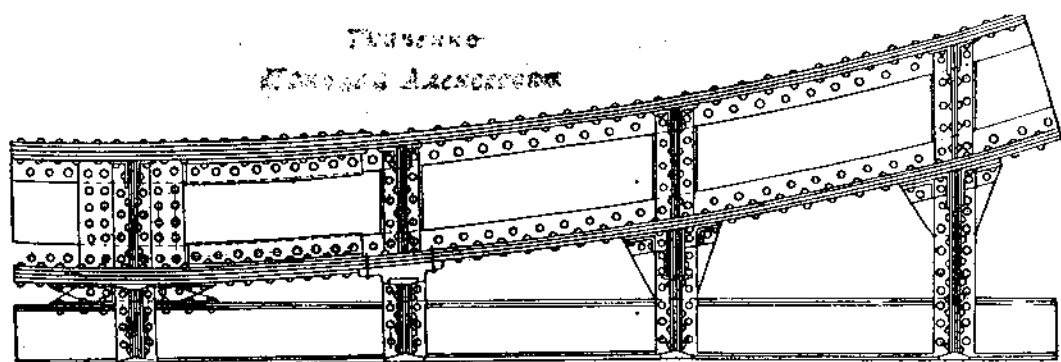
Узел тяжелой арочной фермы с ездой по низу
